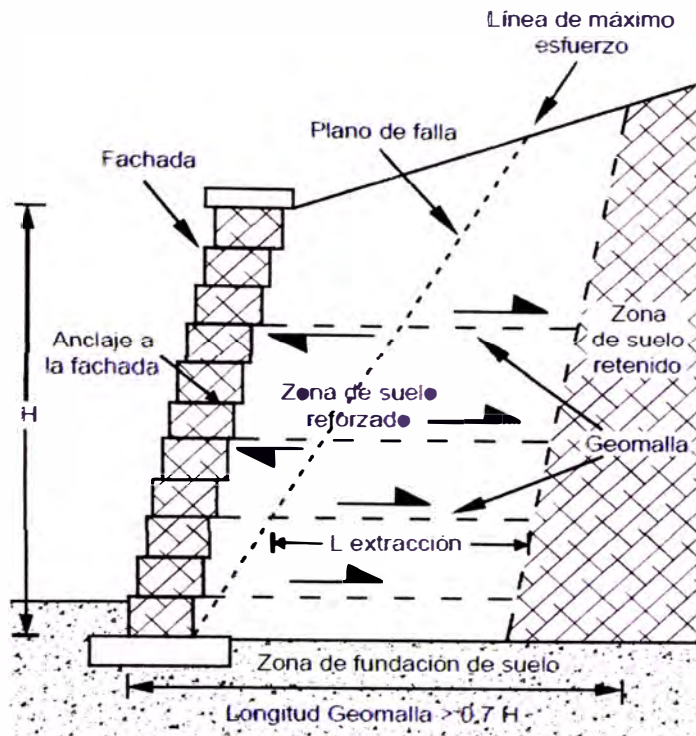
Muros de tierra mecánicamente estabilizada (MSE)
